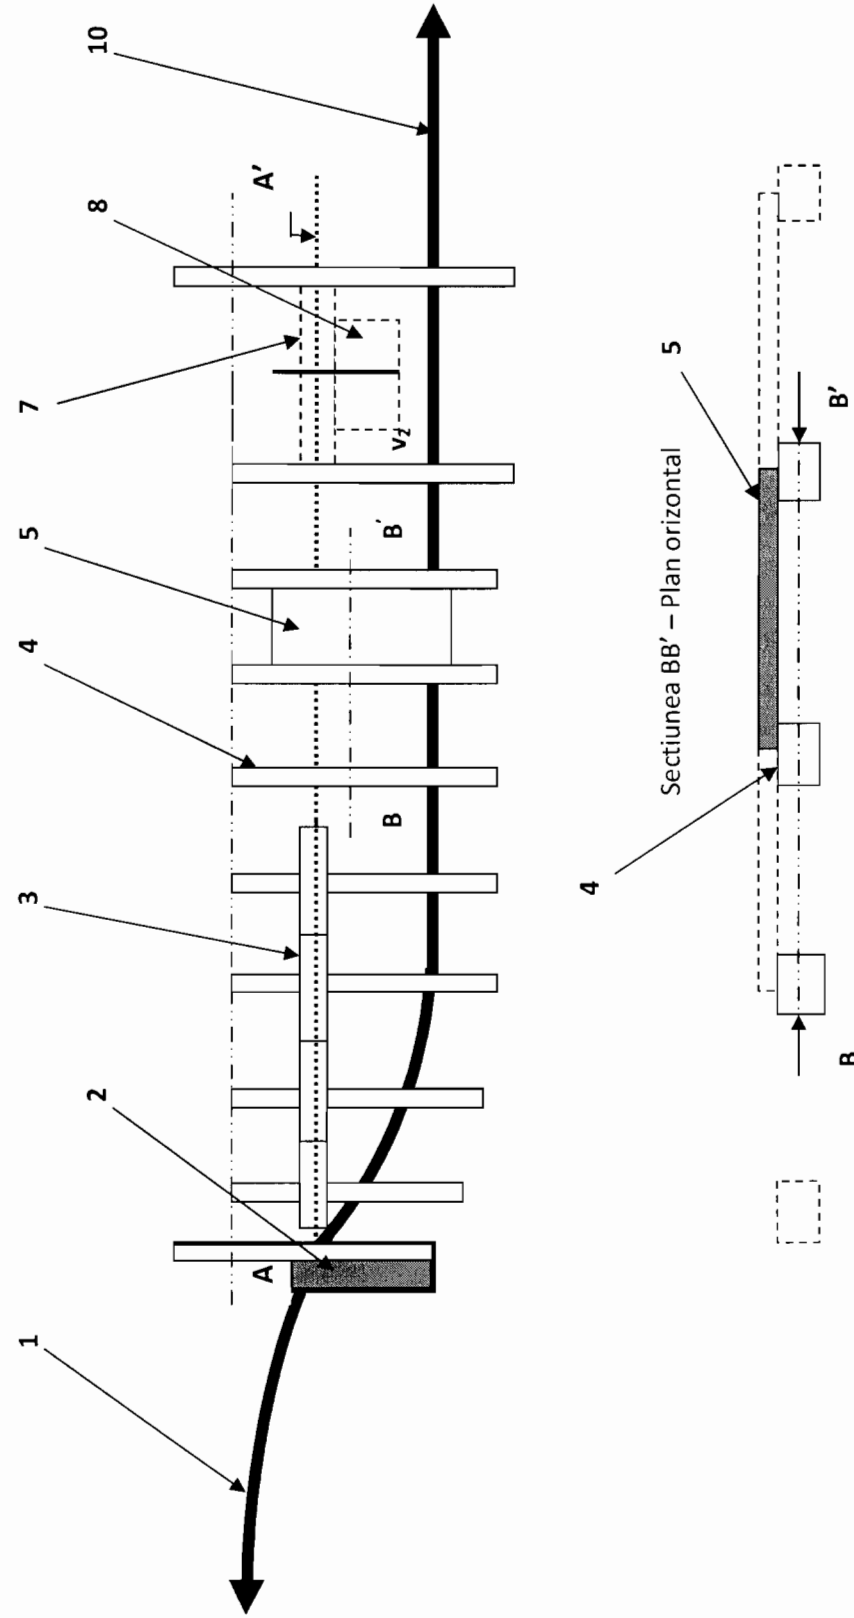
/9 : Construirea hidro tornadei pe malul raului.
